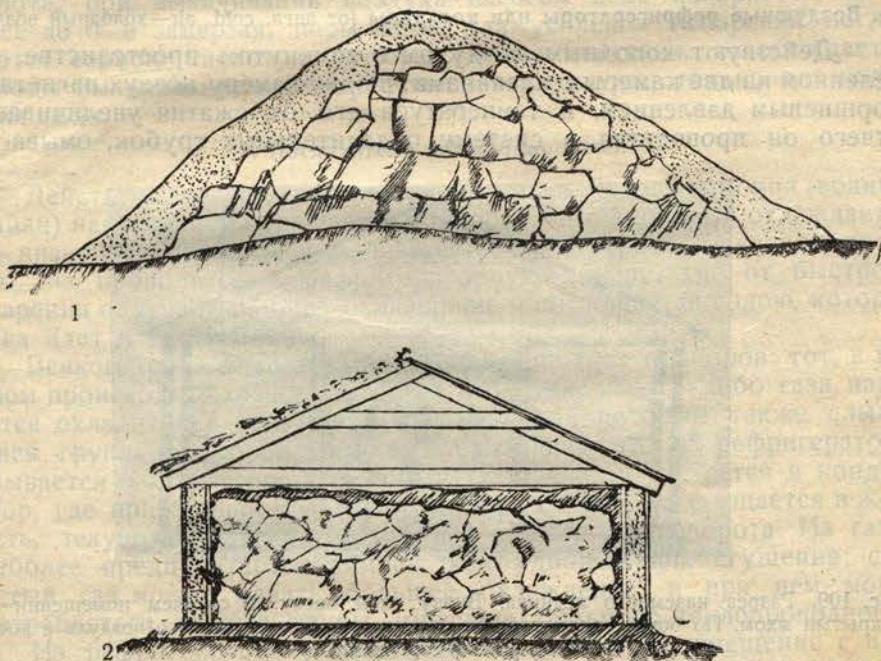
1) Наземная куча льда под слоем опилок; помещается в тени деревьев или прикрывается соломеною крышею. 2) Наземное хранилище льда с двойными стенками; крыша с одной стороны соломенная, с другой тесовая. Сверху льда и между стенками опилки; внизу — песок.
